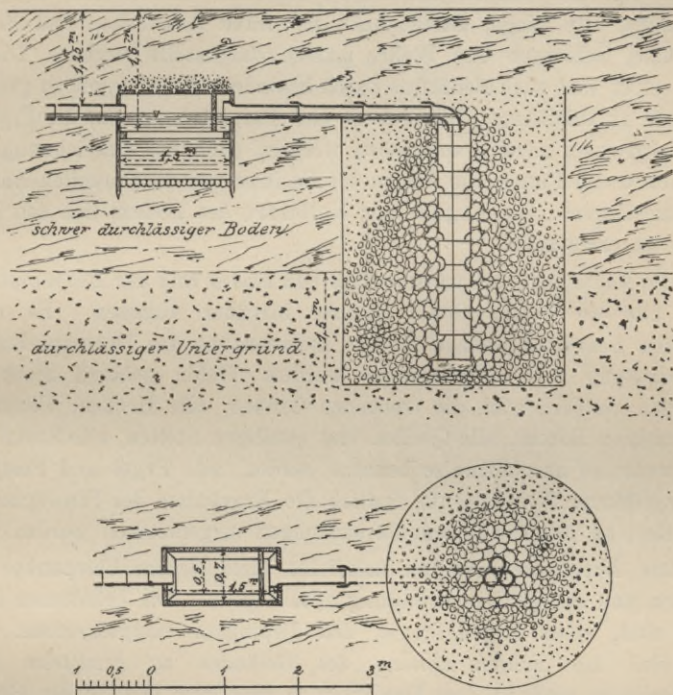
und 406. Senkbrunnen mit Schlammfang. Längenschnitt und Grundriß.
